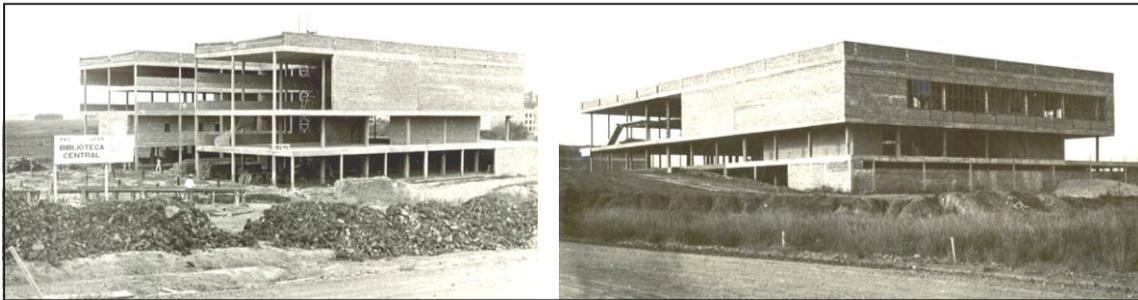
Fotos da Biblioteca em construção (FONTE: PAVEZI, 2010 p.51 e p.70).
